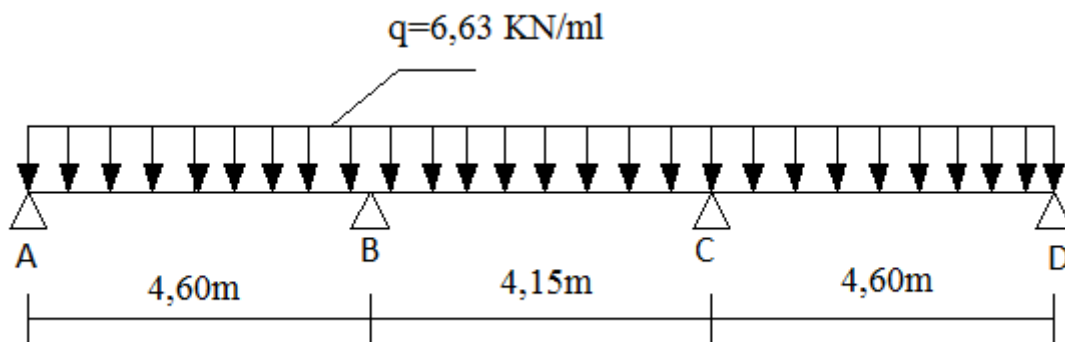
Schéma statique de la poutre continue reposant sur 4 appuis
